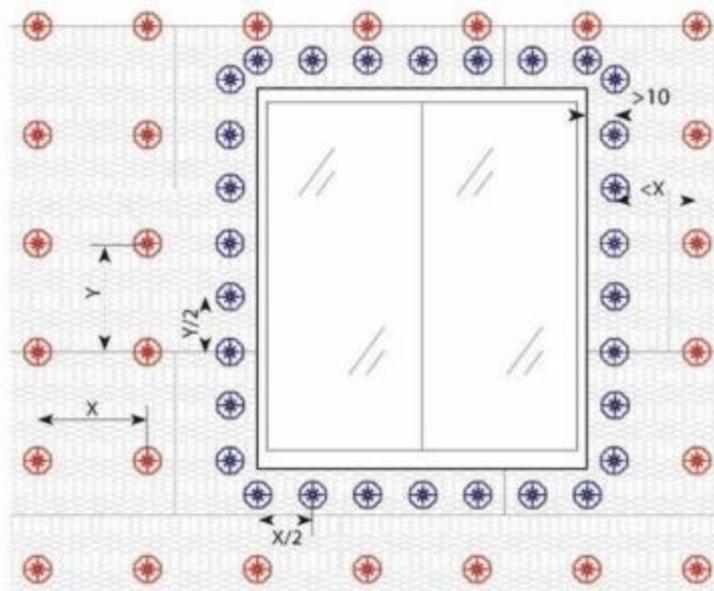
Plans de chevillage avec Baunit StarTrack
